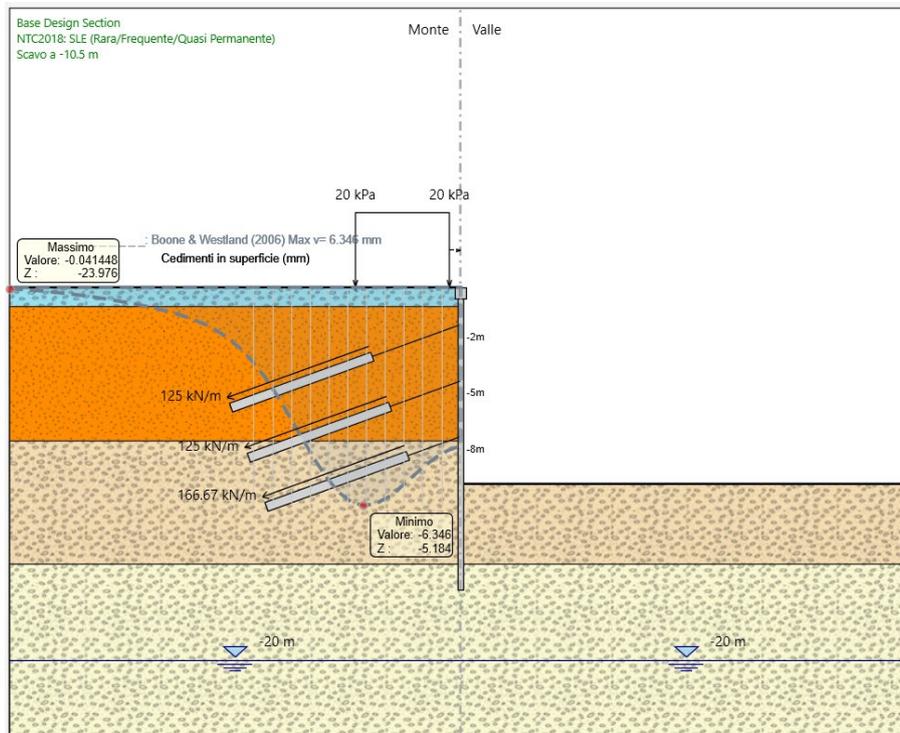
Sezione Tipo D – Spostamenti stima cedimenti
